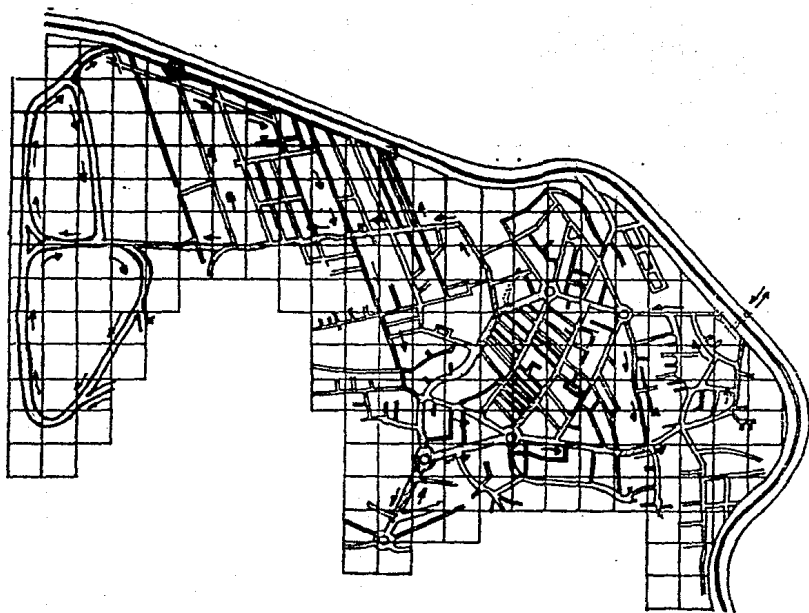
Distribucion de La Red de drenaje y alcantarillado.
